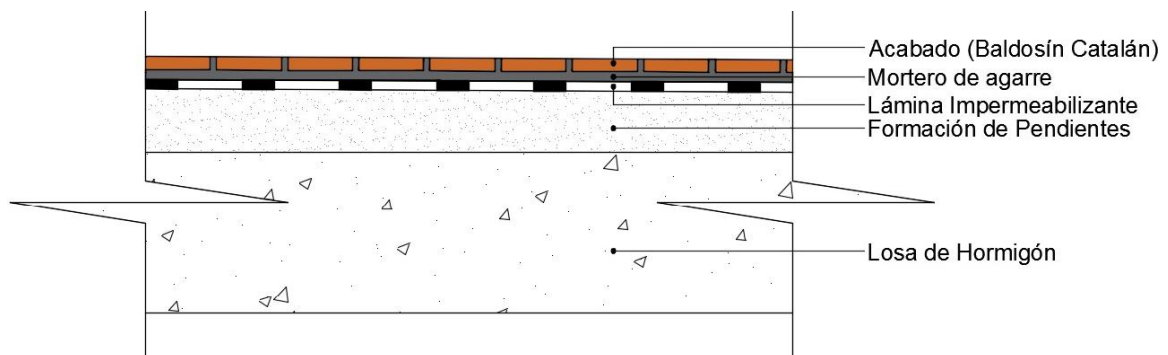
Sección constructiva del cerramiento de la cubierta de los locales comerciales
